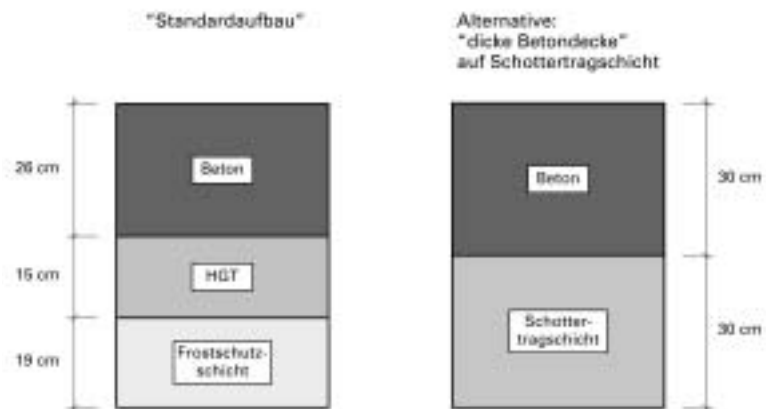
Standardisierte Betonbauweise: Standardaufbau und als Alternative die „dicke Betondecke“ auf Schottertragschicht
